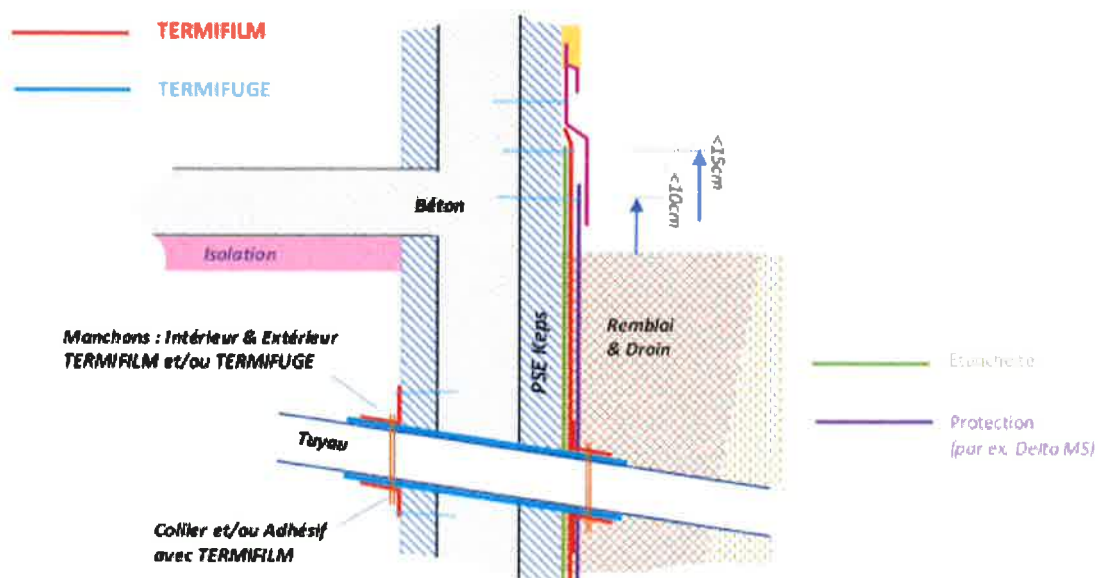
Schémas de principe de la barrière anti-termite autour d'une traversée de mur
